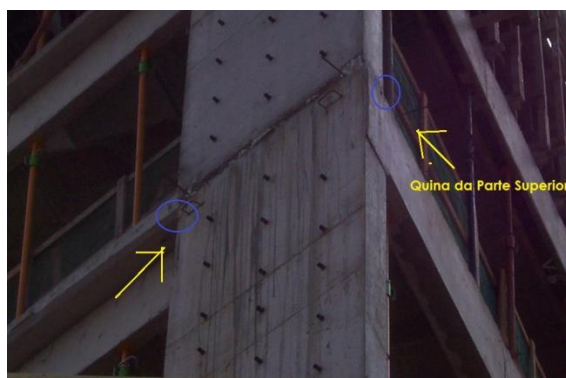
Pontos-objeto formados pela intersecção do pilar 8 e as vigas de cada laje da edificação.
